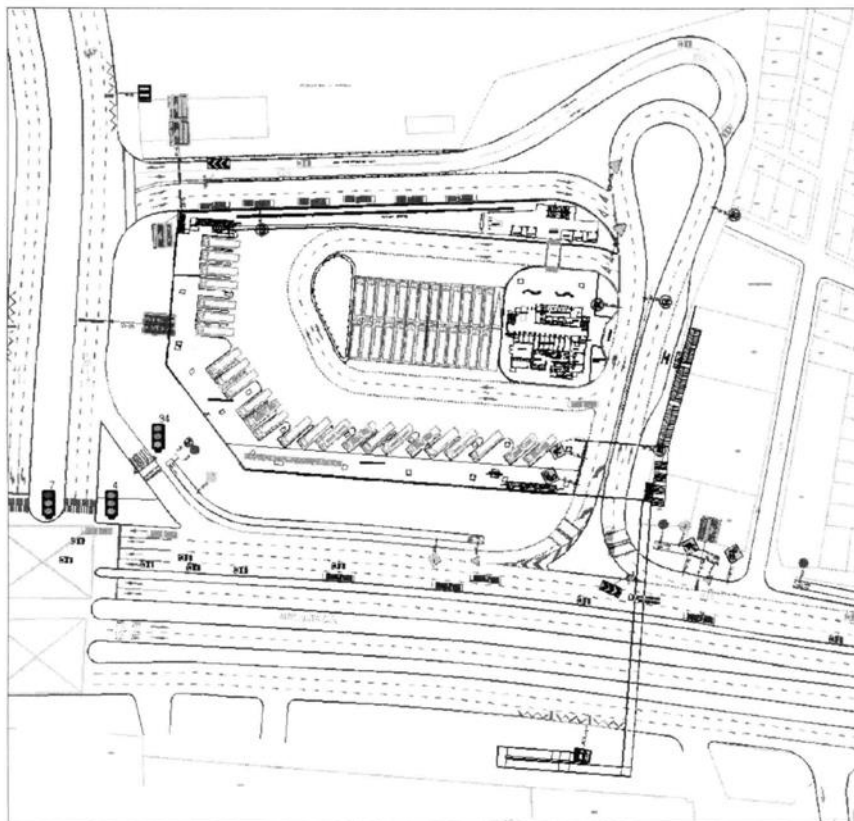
Plano operativo primer nivel Terminal Satélite Sur Escenario 1
